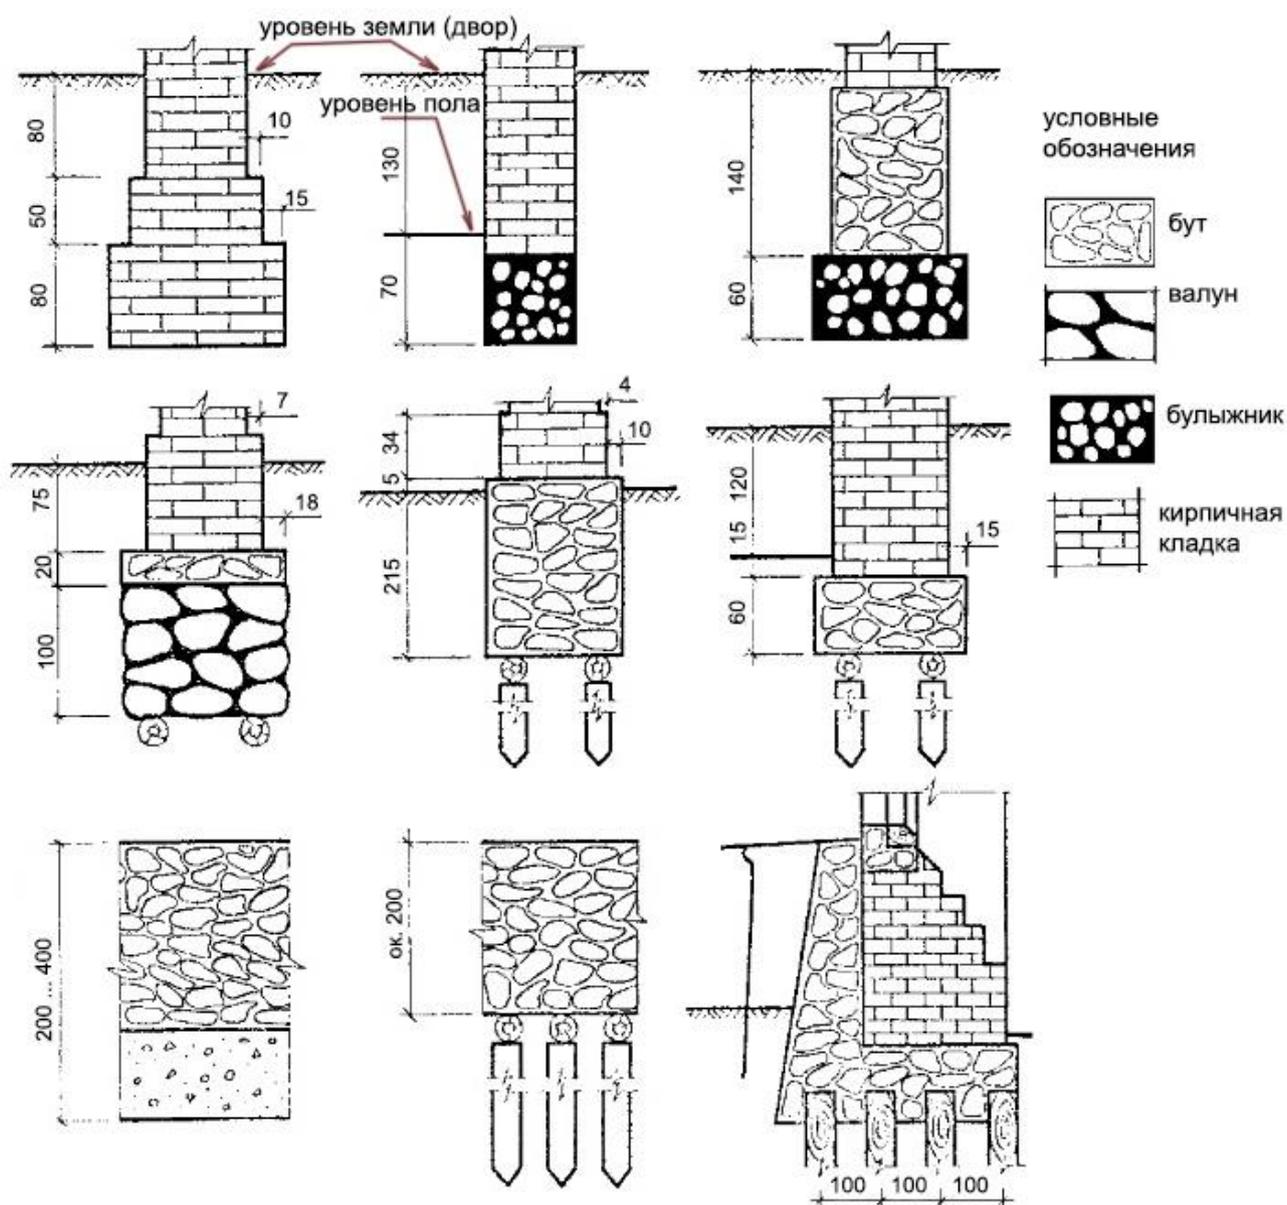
Кладка фундаментов петербургских жилых зданий, построенных до начала XX века (размеры указаны в см) [19]
